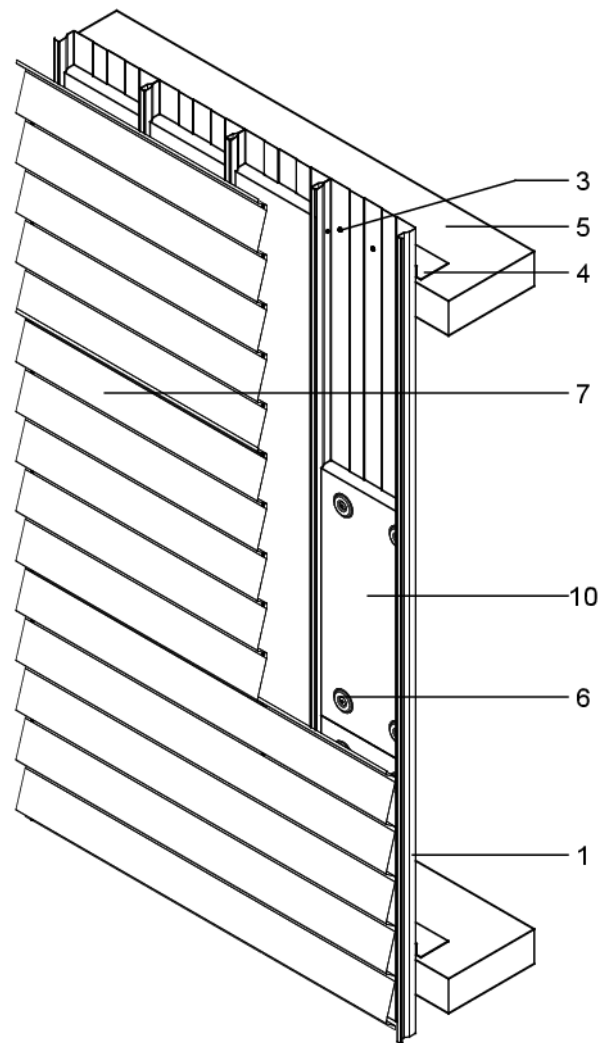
Vista general de sistema Eurohabitat 80 con aislamiento y revestimiento exterior.
